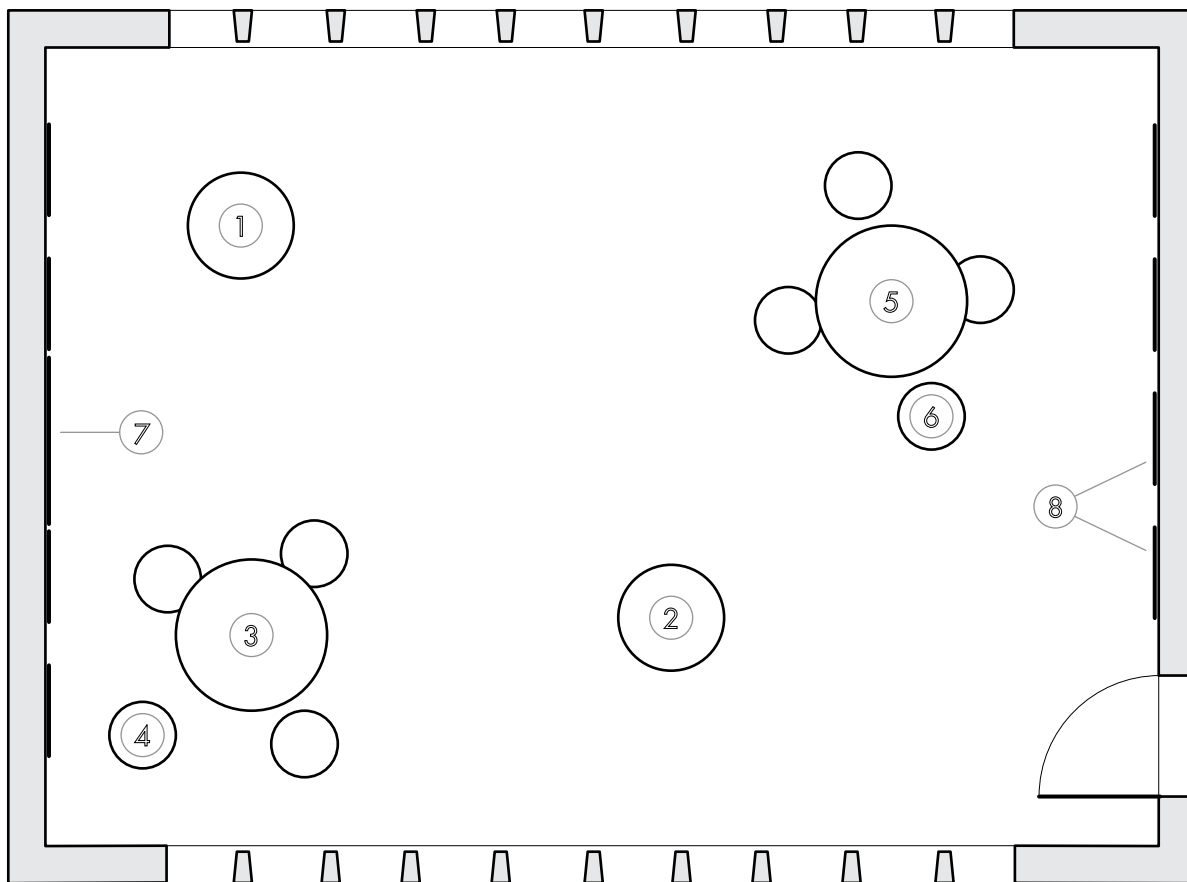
Planta do espaço de implementação de dimensões ideais.
